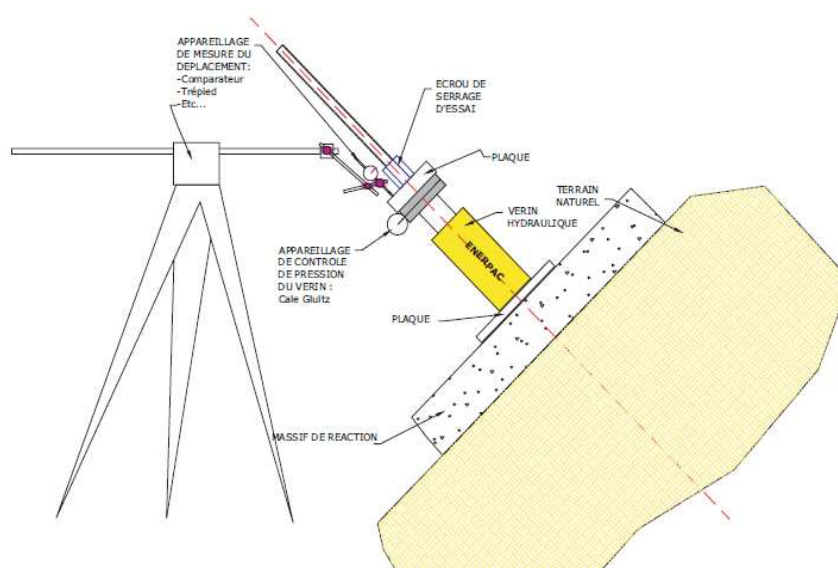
Schéma de principe d'un essai d'arrachement.
